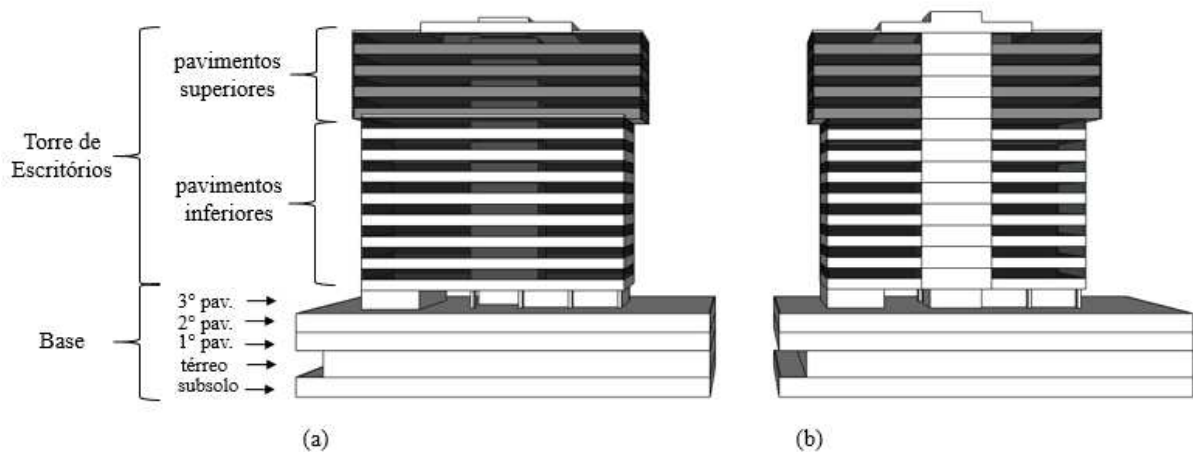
(a) Perspectiva da fachada norte e (b) perspectiva da fachada sul
